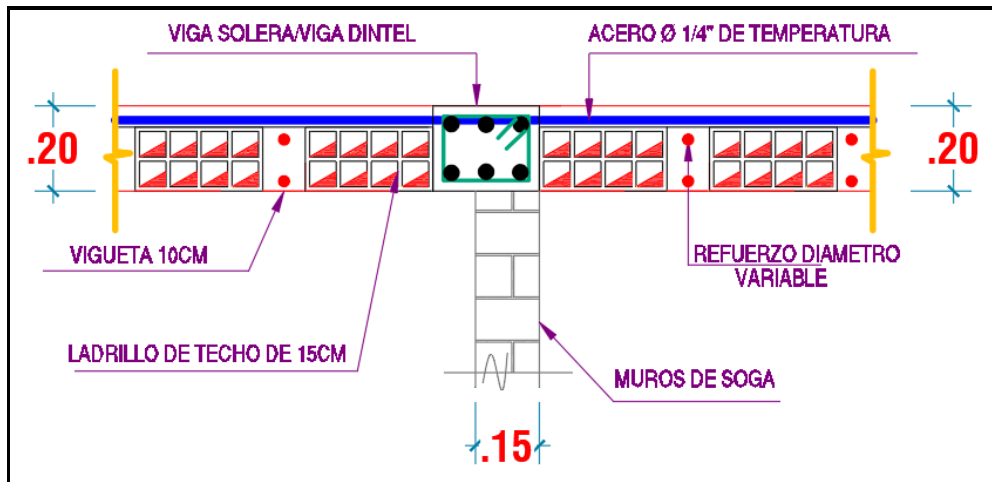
Detalle seccional de losa aligerada. Elaboración propia
